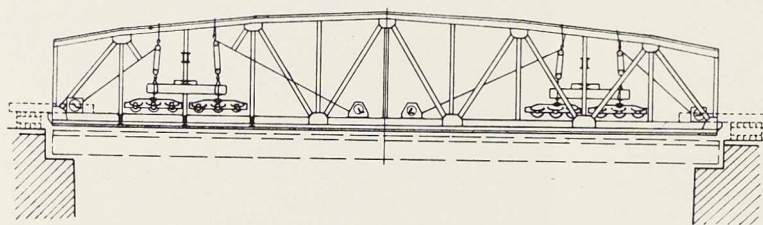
(ci-dessus). Coupe transversale de la travée reposant sur le pont provisoire.
